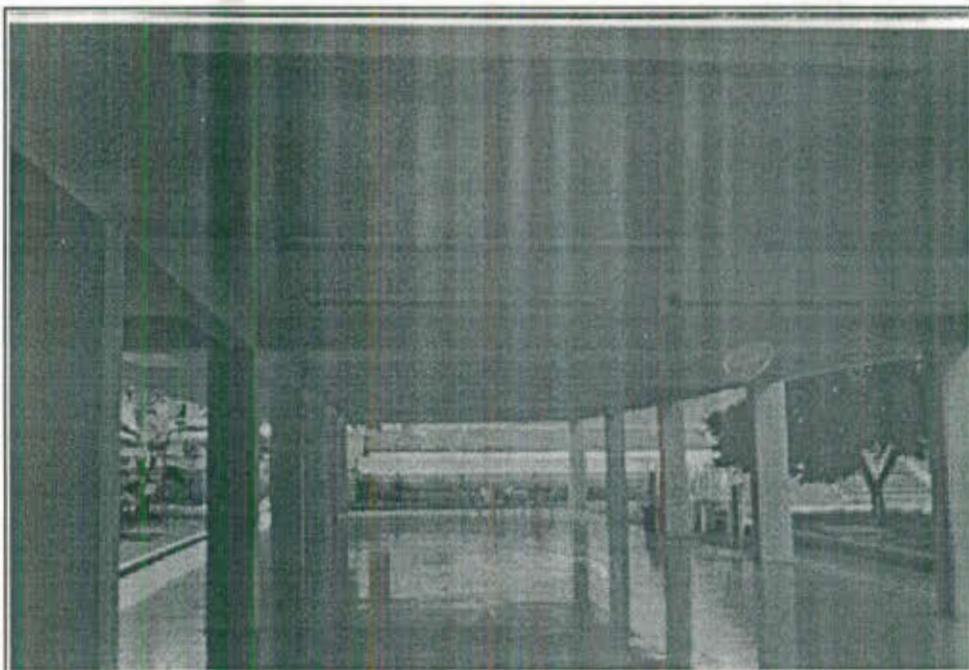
VISTA DE PLANTA BAJA DE AULAS DE COPOL
